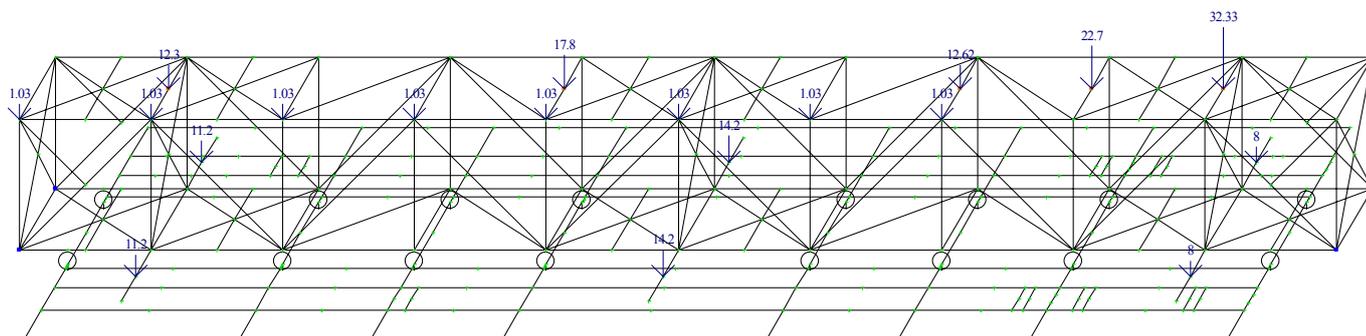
Вертикальные нагрузки от существующих трубопроводов и площадок
